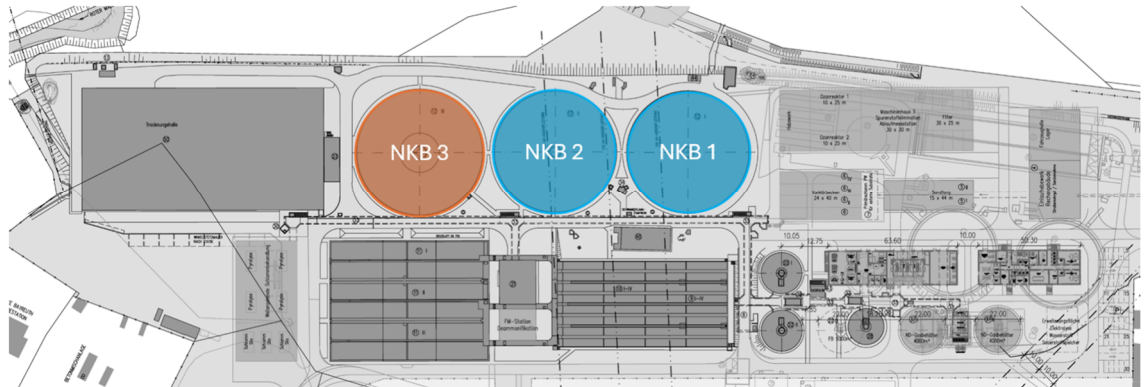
Lageplan bestehendes Nachklärbecken 3 (orange) und zu sanierende Nachklärbecken 1 und 2 (blau)
